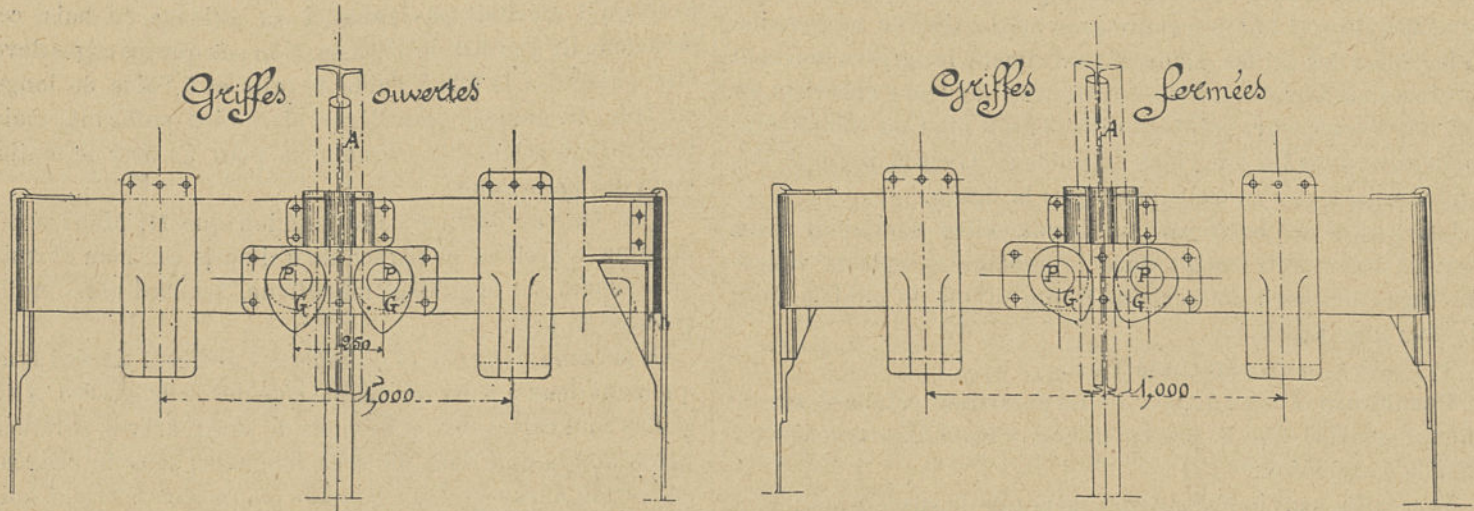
et 11. — Elévations transversales du toit de la cage.
